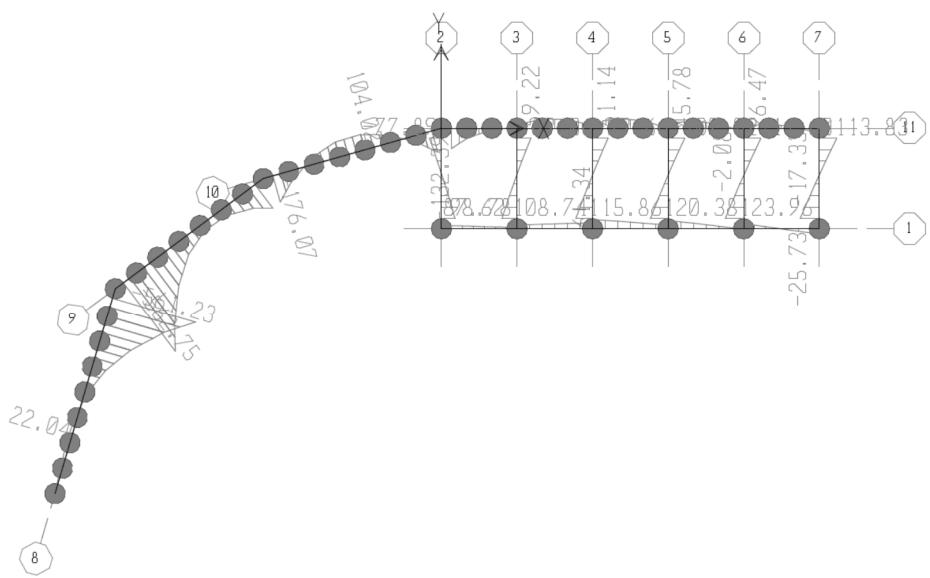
Momentet përkulëse në kN*m, trarët lidhës të pilotave (Pilotat 2)
